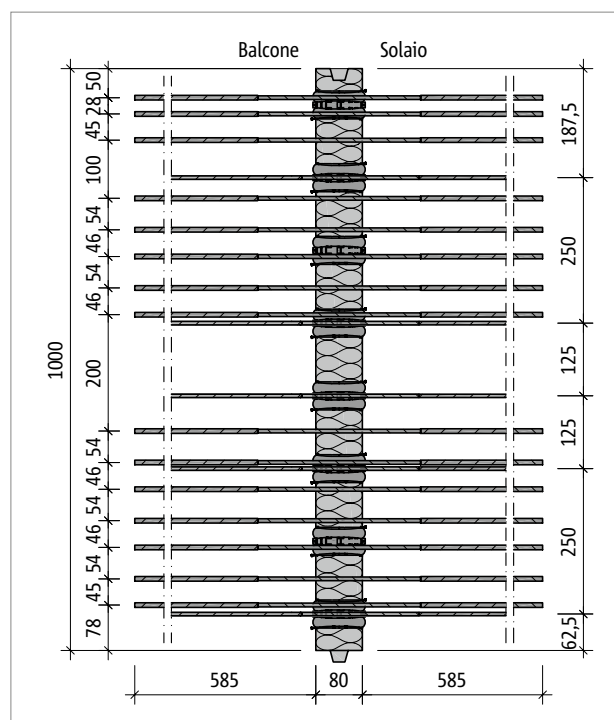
Schöck Isokorb® T tipo K-M6-V1: pianta del prodotto
